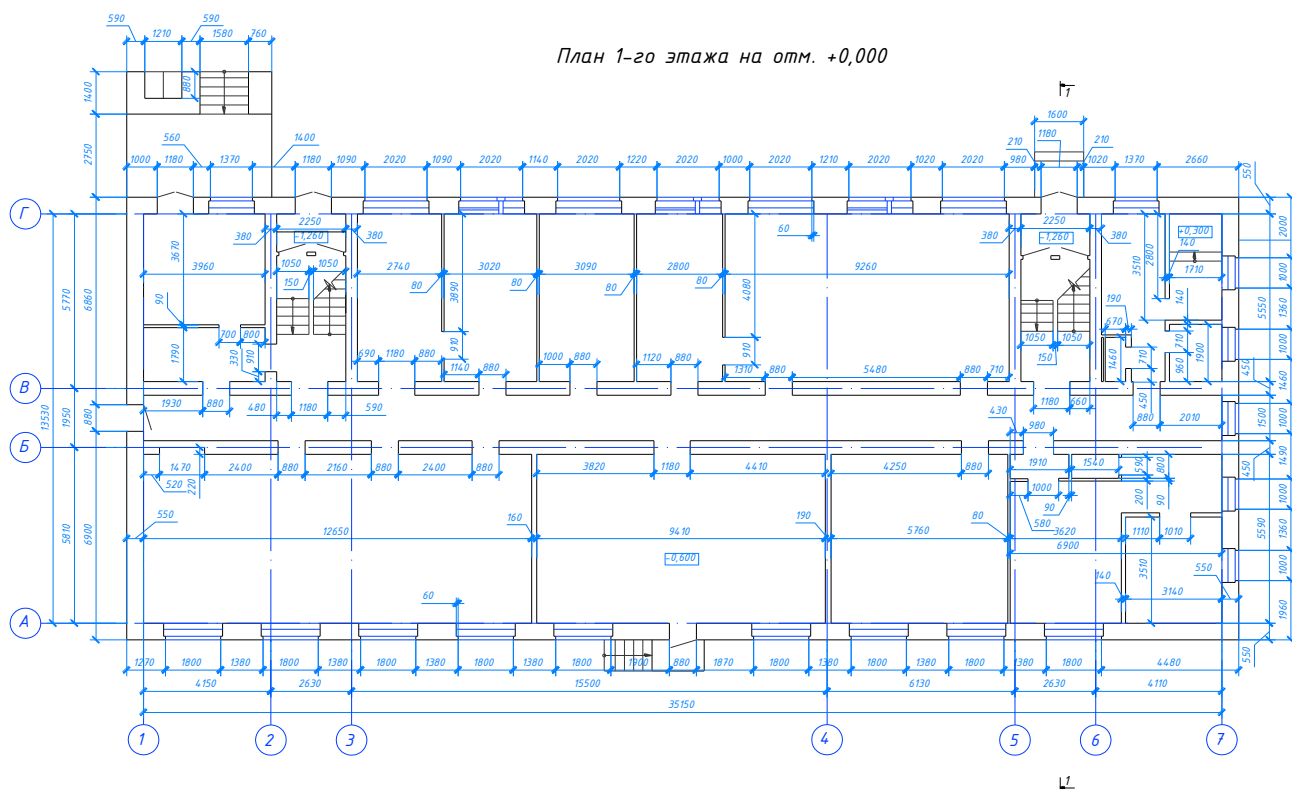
План 1-го этажа 4-этажного здания в г. Новочеркасске
